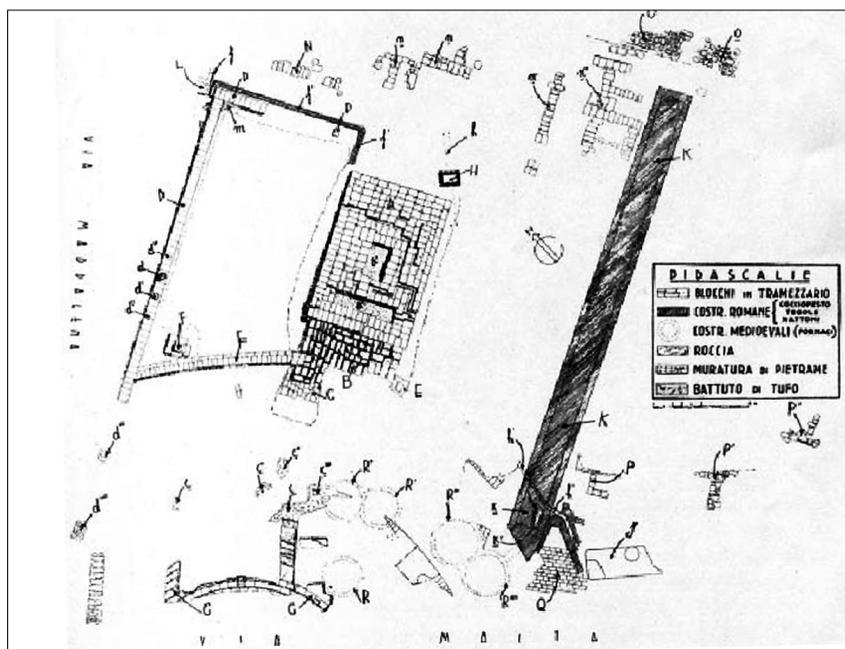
Planimetria del complesso di via Malta (Mingazzini 1949).
